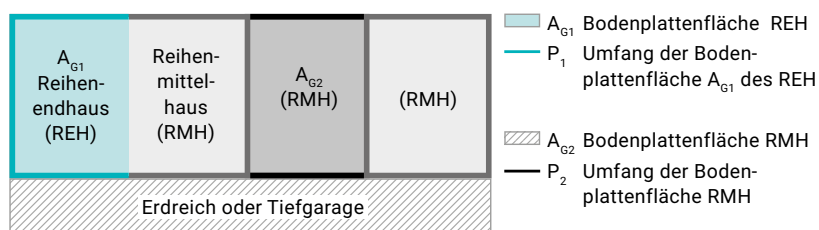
Grundriss UG: Bodenplatte einer Reihenanlage
